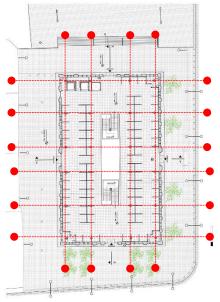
Estructura plaza de mercado cuenca, ecuador.
